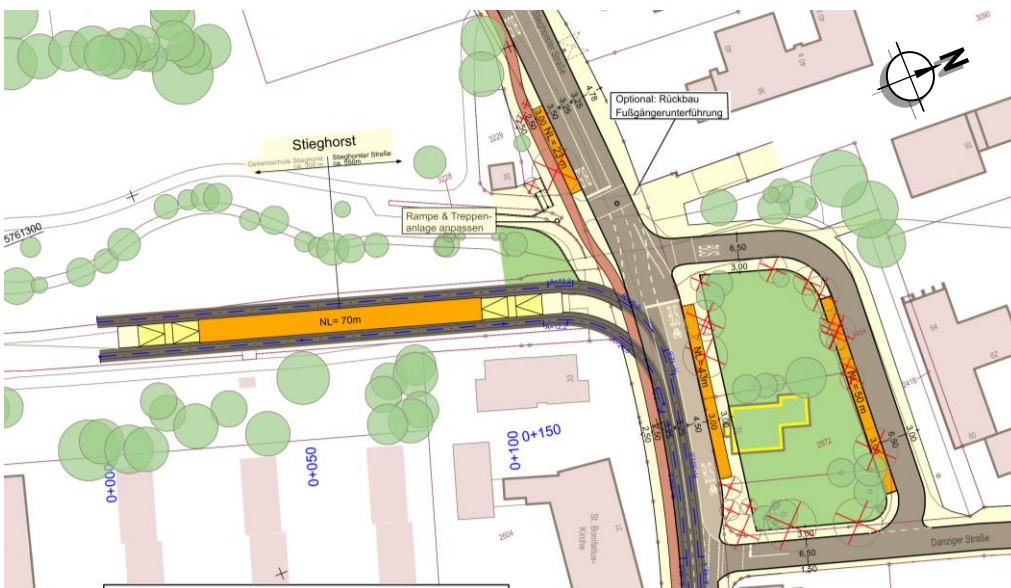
Trassenvariante 2 Lageplan Haltestelle Stieghorst
